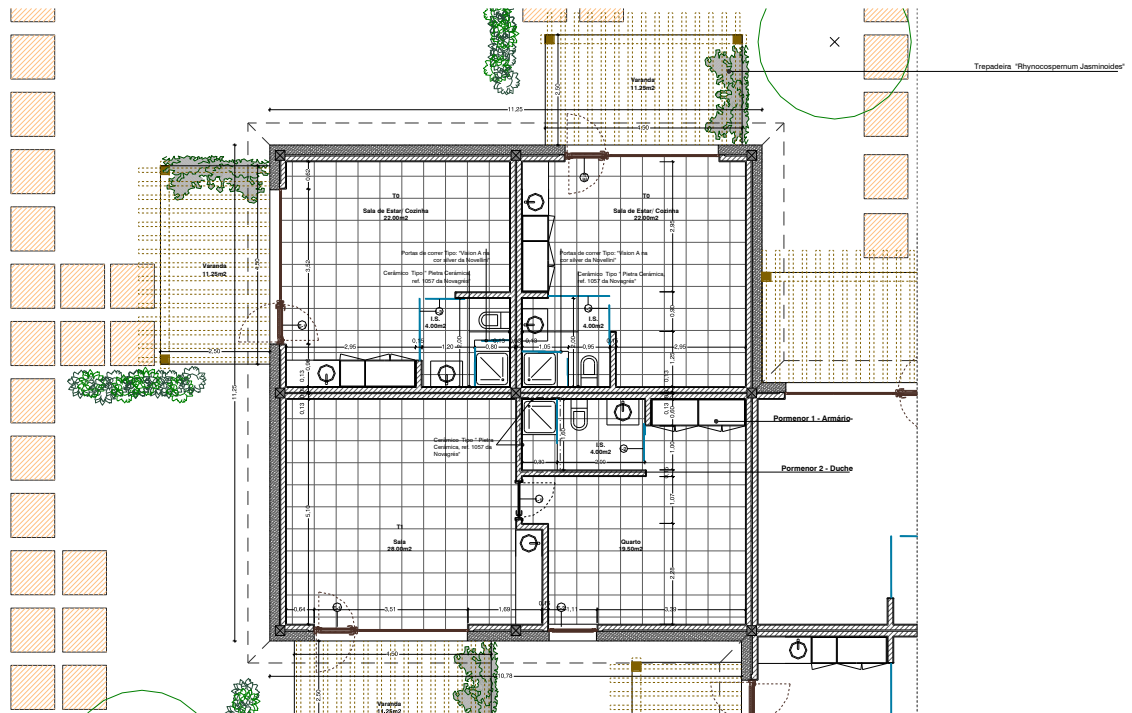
Planta de Apresentação dos Bangalows T0 e T1
